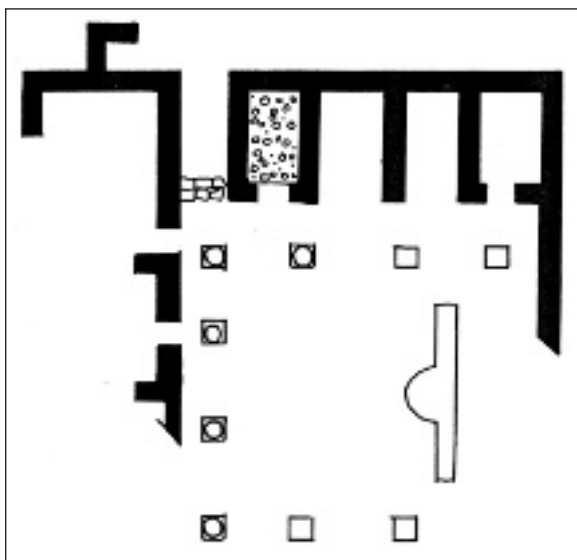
Planta de la villa El Canal (Fuente: B. Ruiz).
